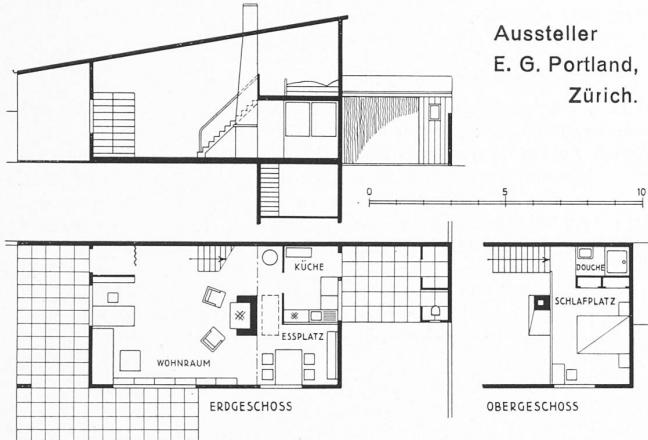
Grundrisse und Schnitt des fugenlosen Betonhauses. — 1 : 250.
